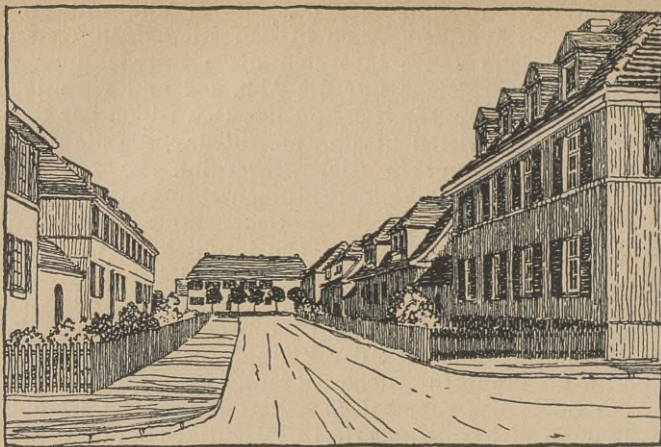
Straße mit abschließendem Quergebäude als Augenzielpunkt. Gartenstadt Wedau. Architekt Grod
